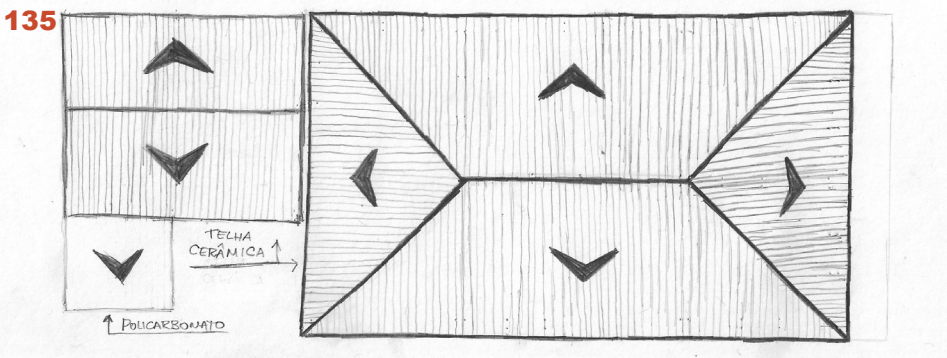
Planta de cobertura da Casa de Seu Salvador.
